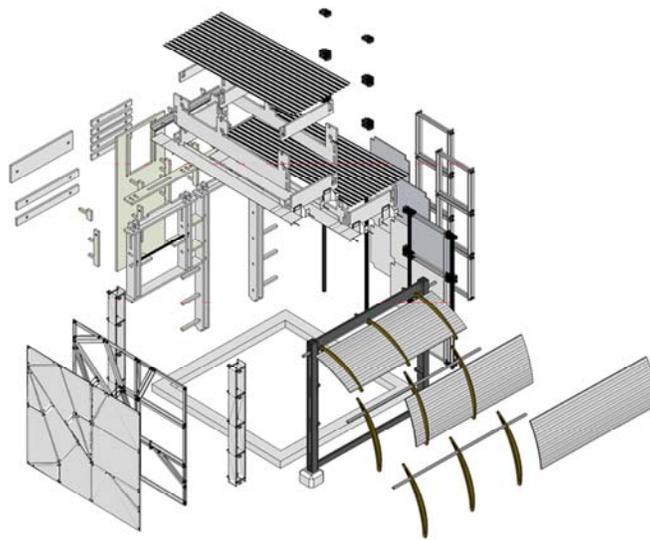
Arriba a la izquierda, diagrama de la propuesta de los componentes estructurales para fundaciones, columnas, machones y muros. En el centro, encofrado modular para vigas. A la derecha, encofrado para vigas de riostra y vigas acarteladas. (Mario Torres, 2011)
